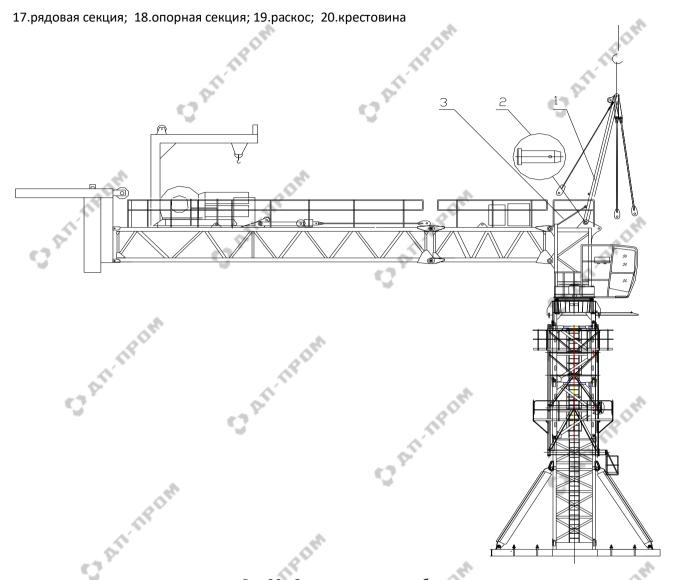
Строповка оголовка башни 1.конструкция оголовка башня; 2.палец; 3. маленький раскос
